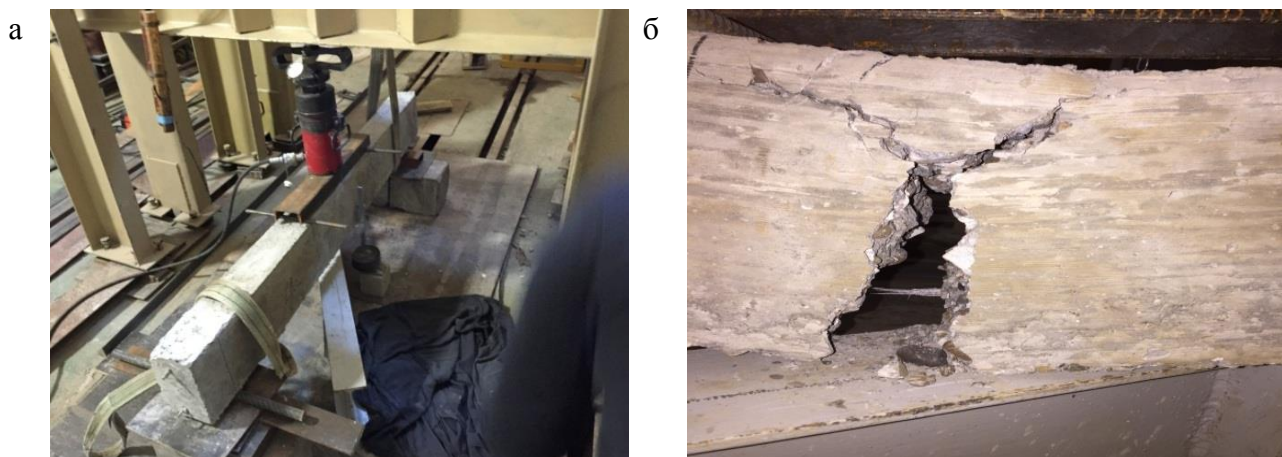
Испытание опытных балок: а) схема нагружения опытной балки; б) характер разрушения балки (рисунок авторов)
